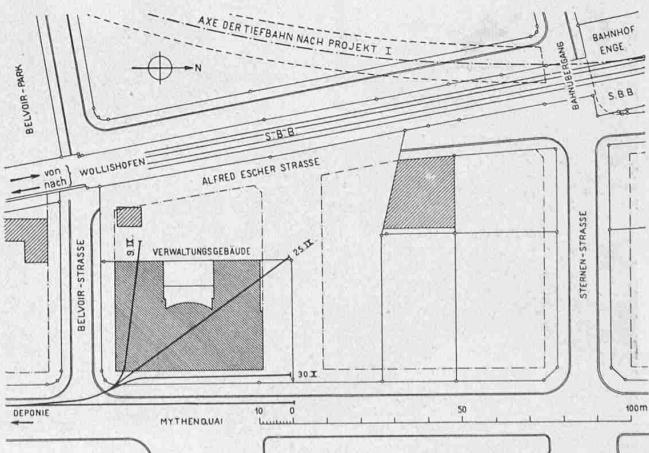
Lageplan der Baustelle mit verschiedenen Geleiseanlagen. Masstab 1:2000.
